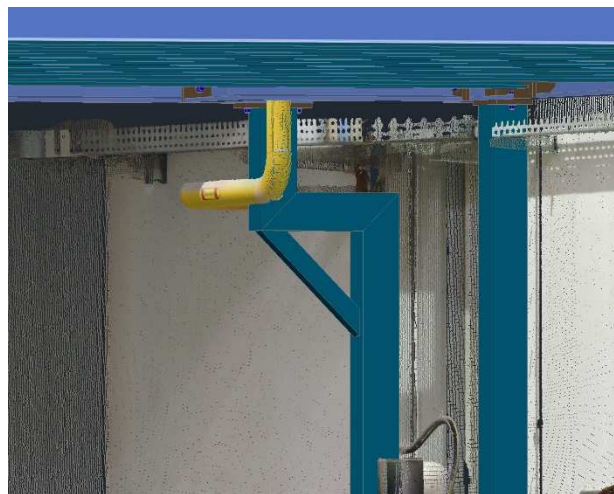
Detail aus Stahlbau Planung mit Punktwolke
